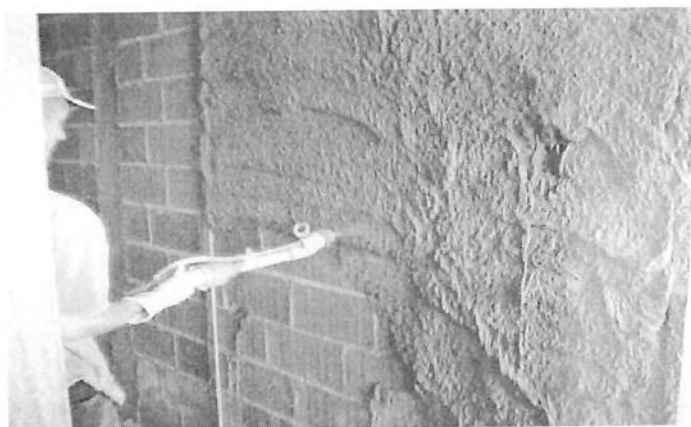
Foto de operário projetando argamassa na parede (Obra SP 80).
